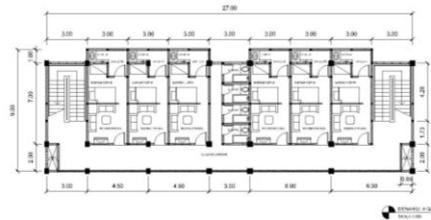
Denah Lantai 2-4 Blok A,B,C (tipe sama)
